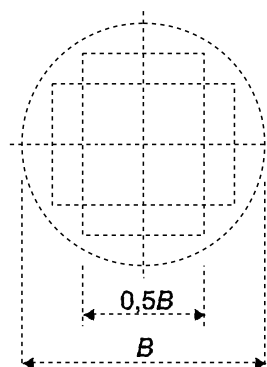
Ортогональная арматура в круглых отдельных фундаментах на грунте
